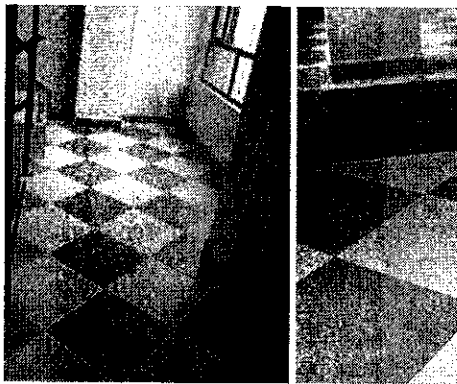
Afectación típica en acabados de piso en el eje de inicio de los voladizos, presencia de fisuras
